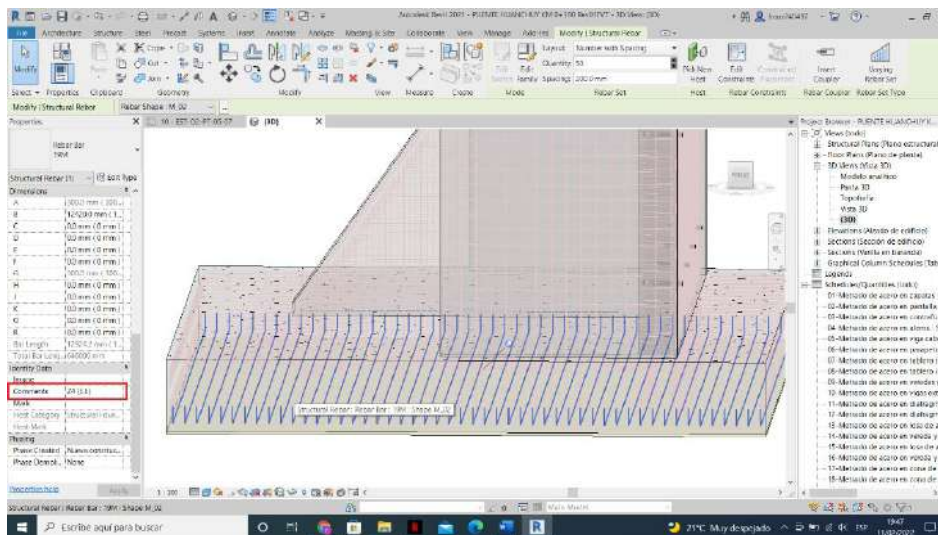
Modelado de los aceros de pantalla, viga cabezal, ménsula y parapeto del estribo del puente Huanchuy
